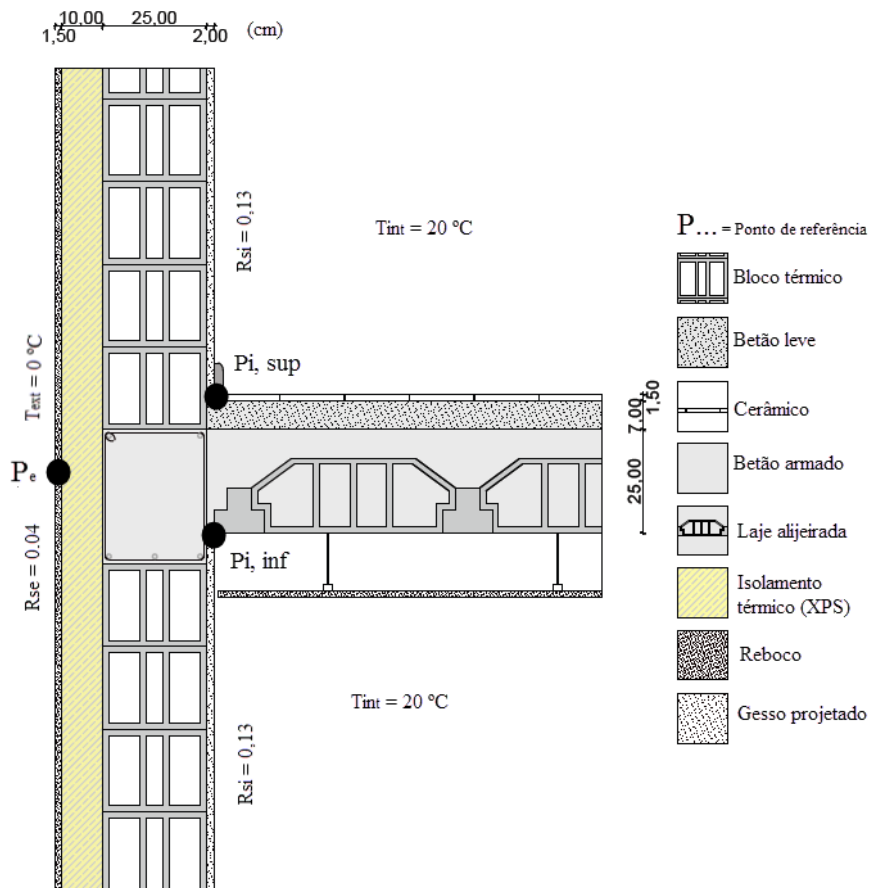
Ligação de fachada (parede simples) com pavimentos intermédios
